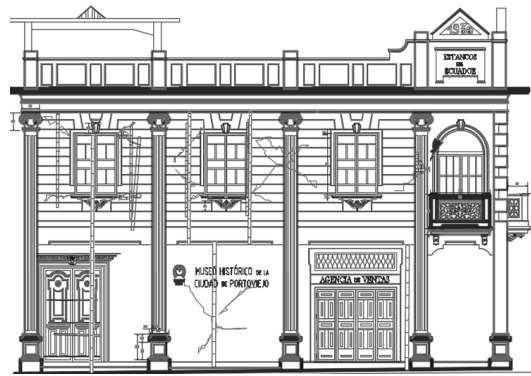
Levantamiento de fachada de la Casa de los Estancos sobre la calle Teodoro Wolf. (INPC, 2017)
